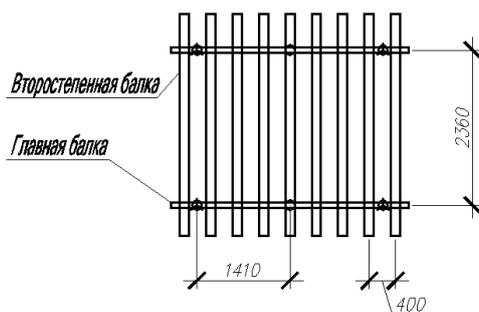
Расстановка стоек и раскладка балок опалубки
